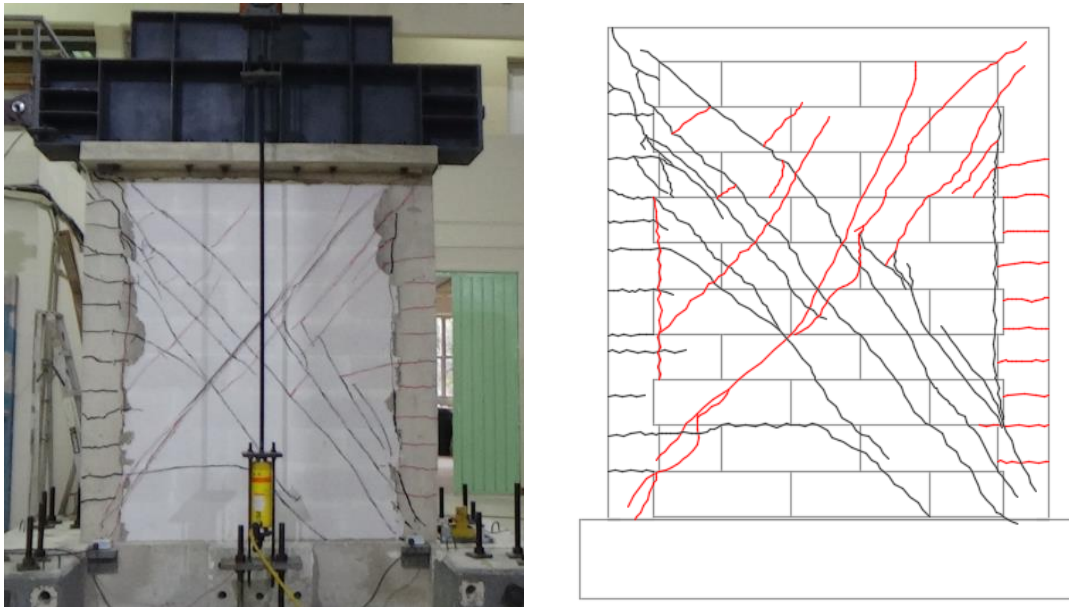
Patrón de agrietamiento final del muro M-1.23-4.8
